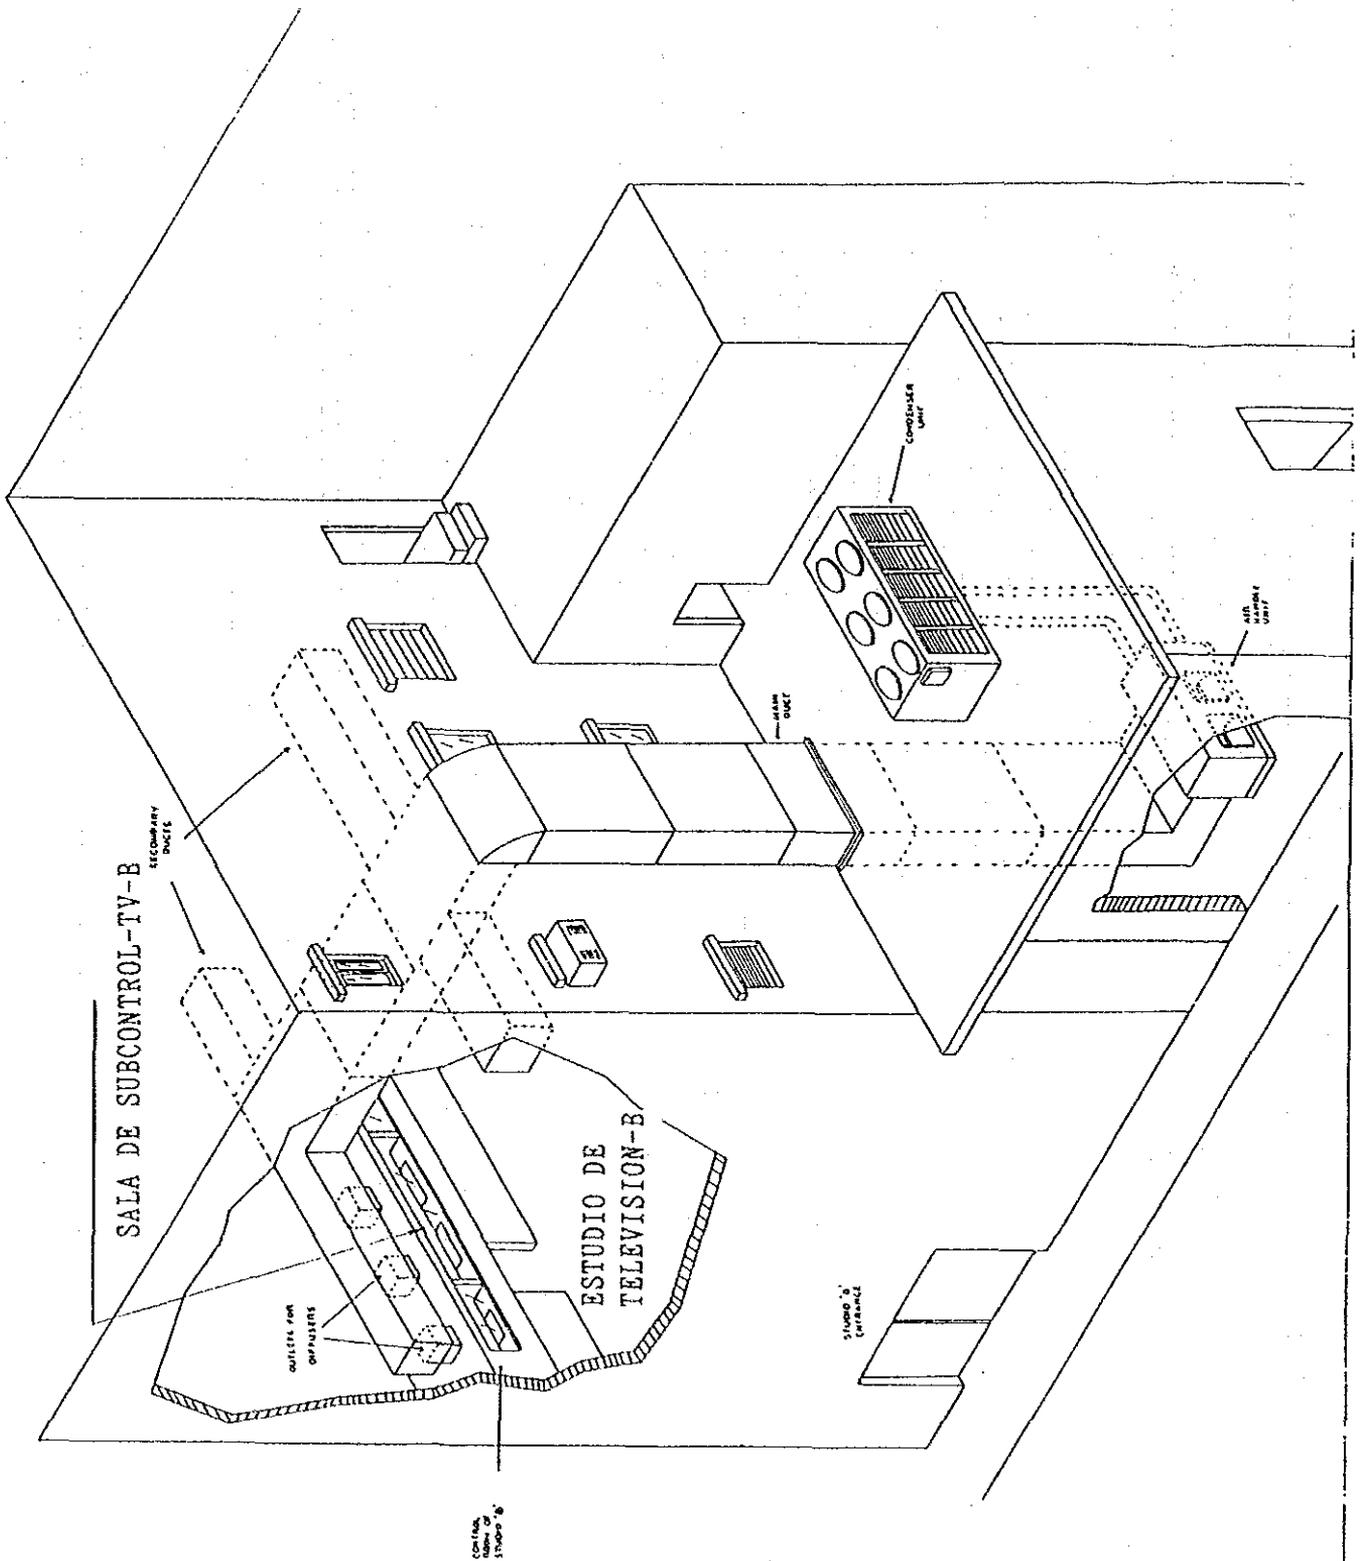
PLANO DE COLOCACION DE AIRE ACONDICIONADO
